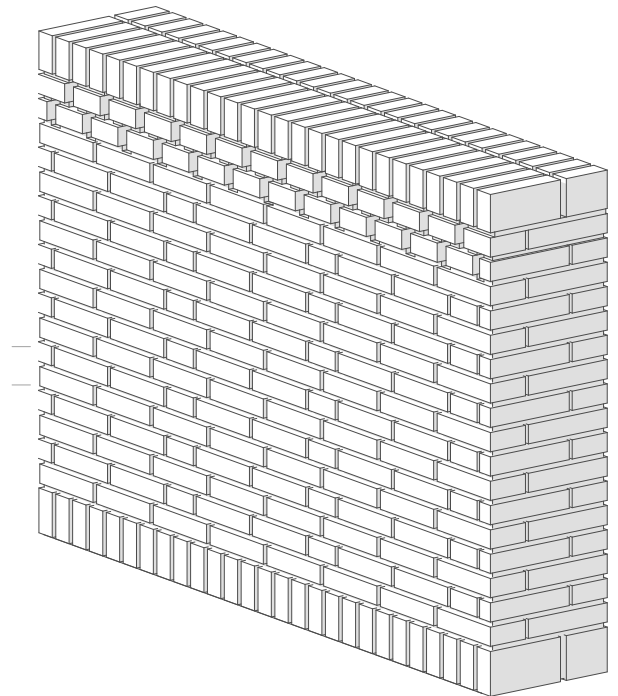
Ilustración del ladrillo en el detalle constructivo 4'.
